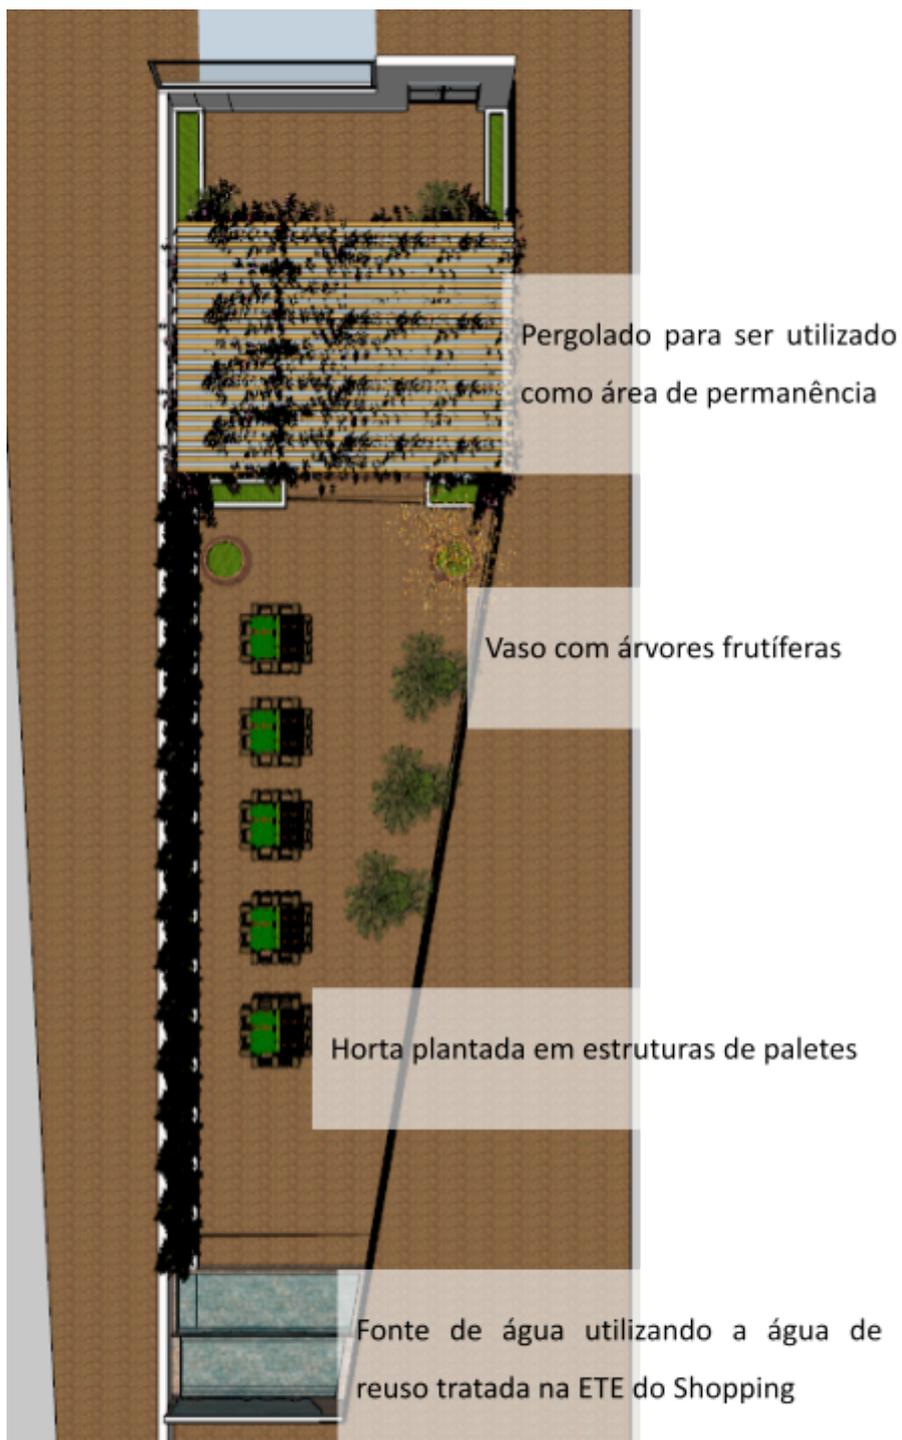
Planta do planejado do local destinado para educação ambiental e horta orgânica
